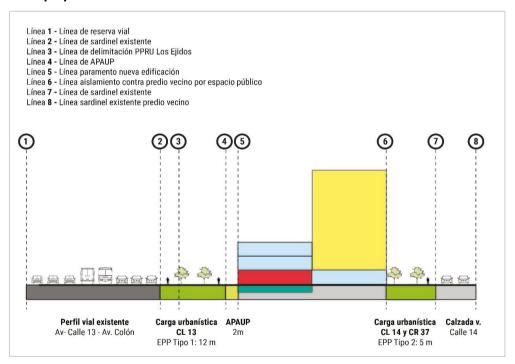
Perfil propuesta urbana Fuente: Elaboración propia
